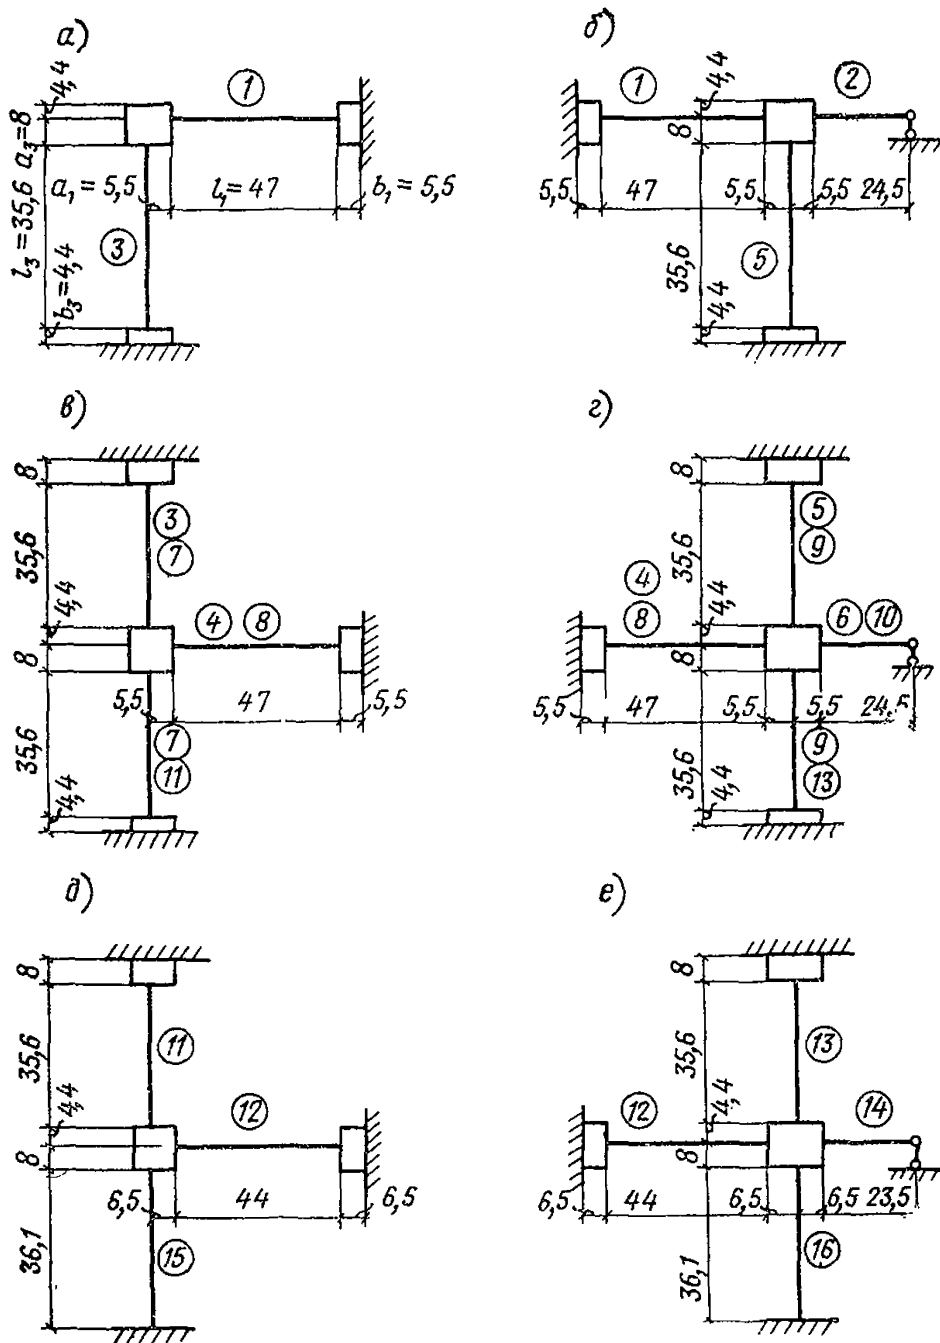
Расчетные схемы узлов поперечной рамы каркаса
